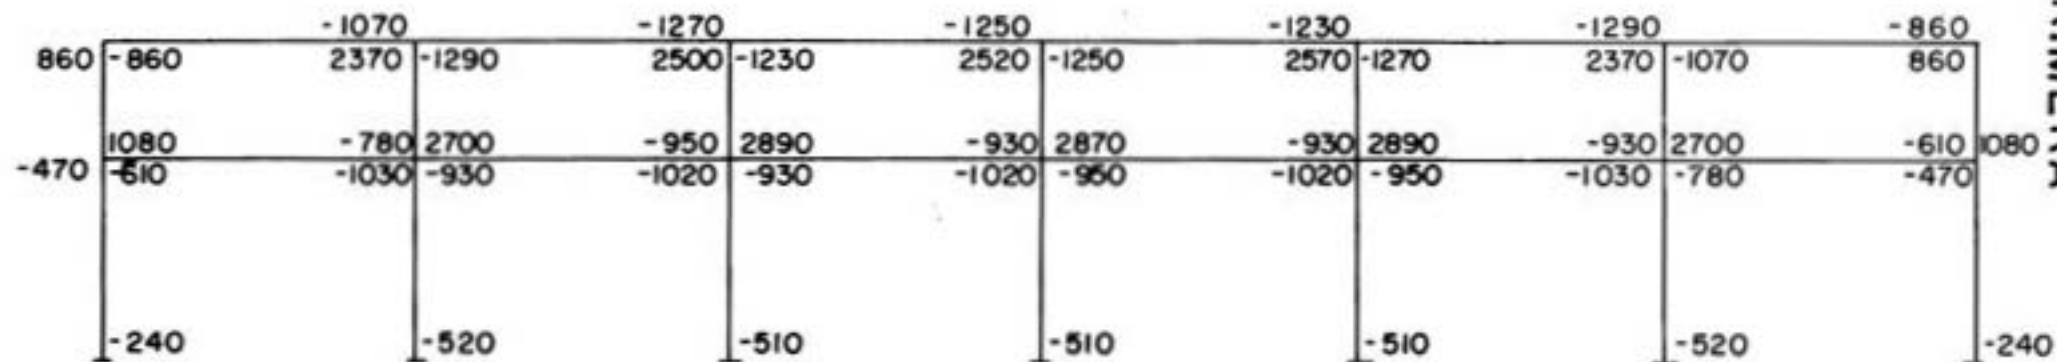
CALCULO DE LAS VIGAS VA-3 Y VA-4 MOMENTOS DEBIDOS A F_1
